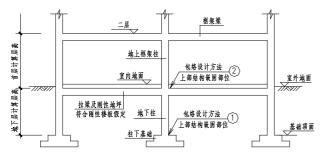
首层地面设置拉梁及钢筋混凝土刚性地坪板
